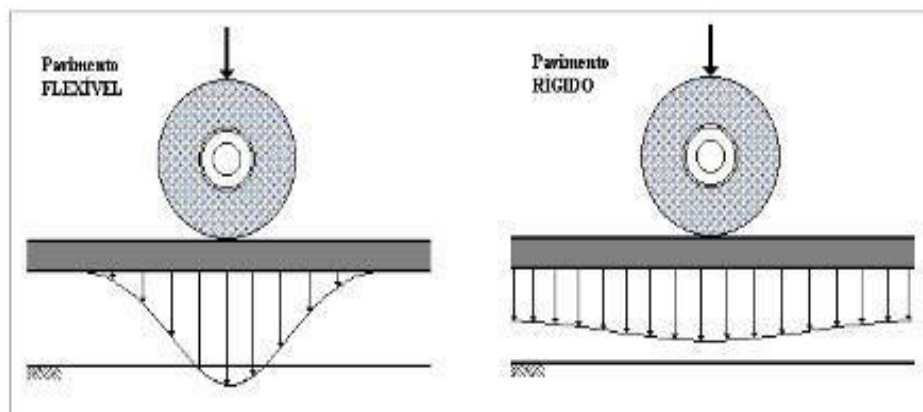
Diferença do comportamento estrutural entre pavimento flexível e pavimento rígido – (Fonte: Senço, 2007)
